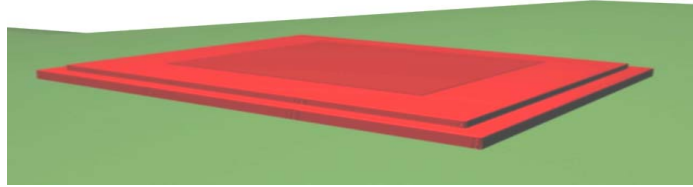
Sistema construtivo, 1º passo: fundação, a base da construção.
